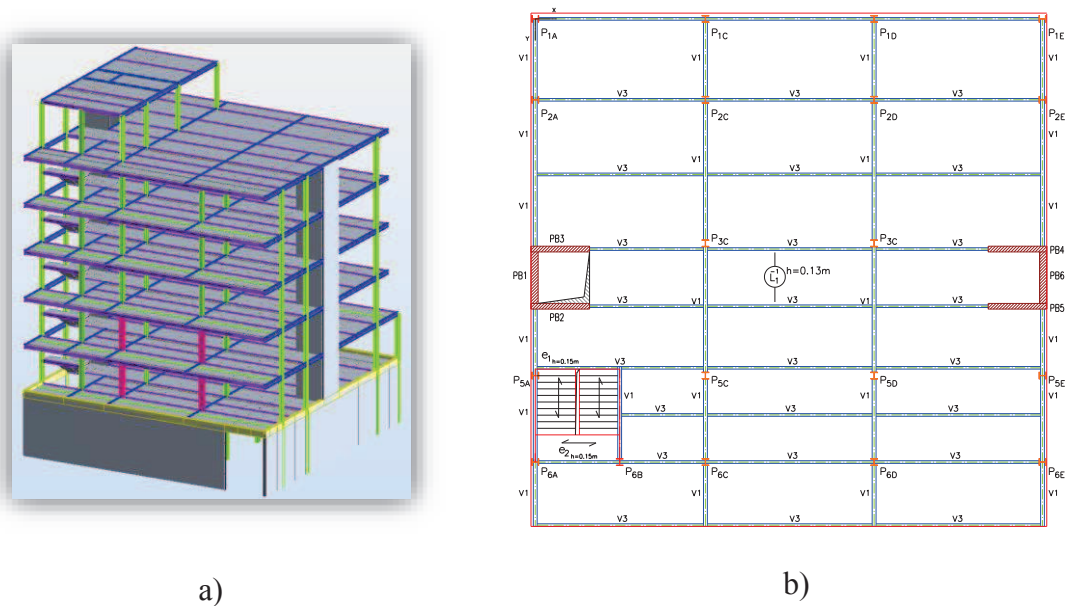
Solução Metálica: a) Modelação Estrutural e b) Planta do piso 1
